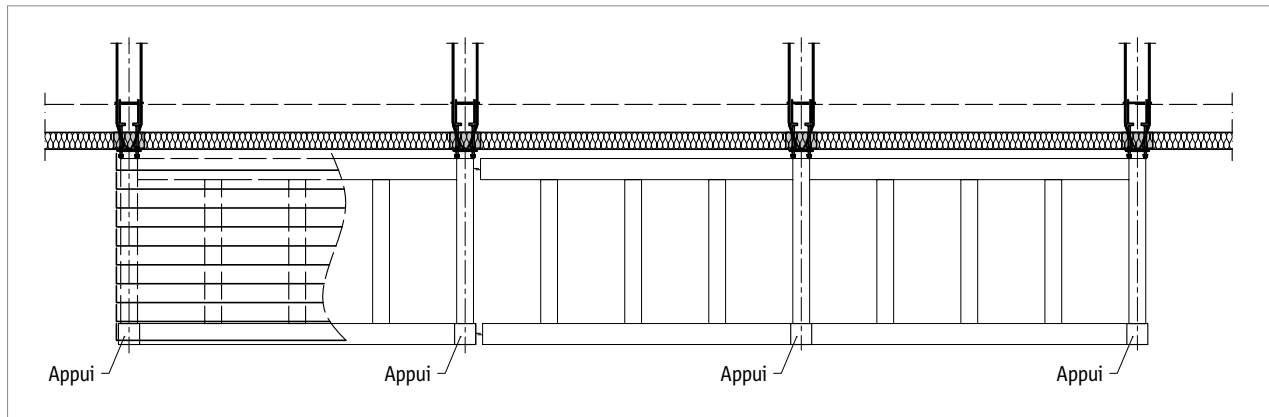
Schöck Isokorb® XT type SQ : balcon sur appuis
